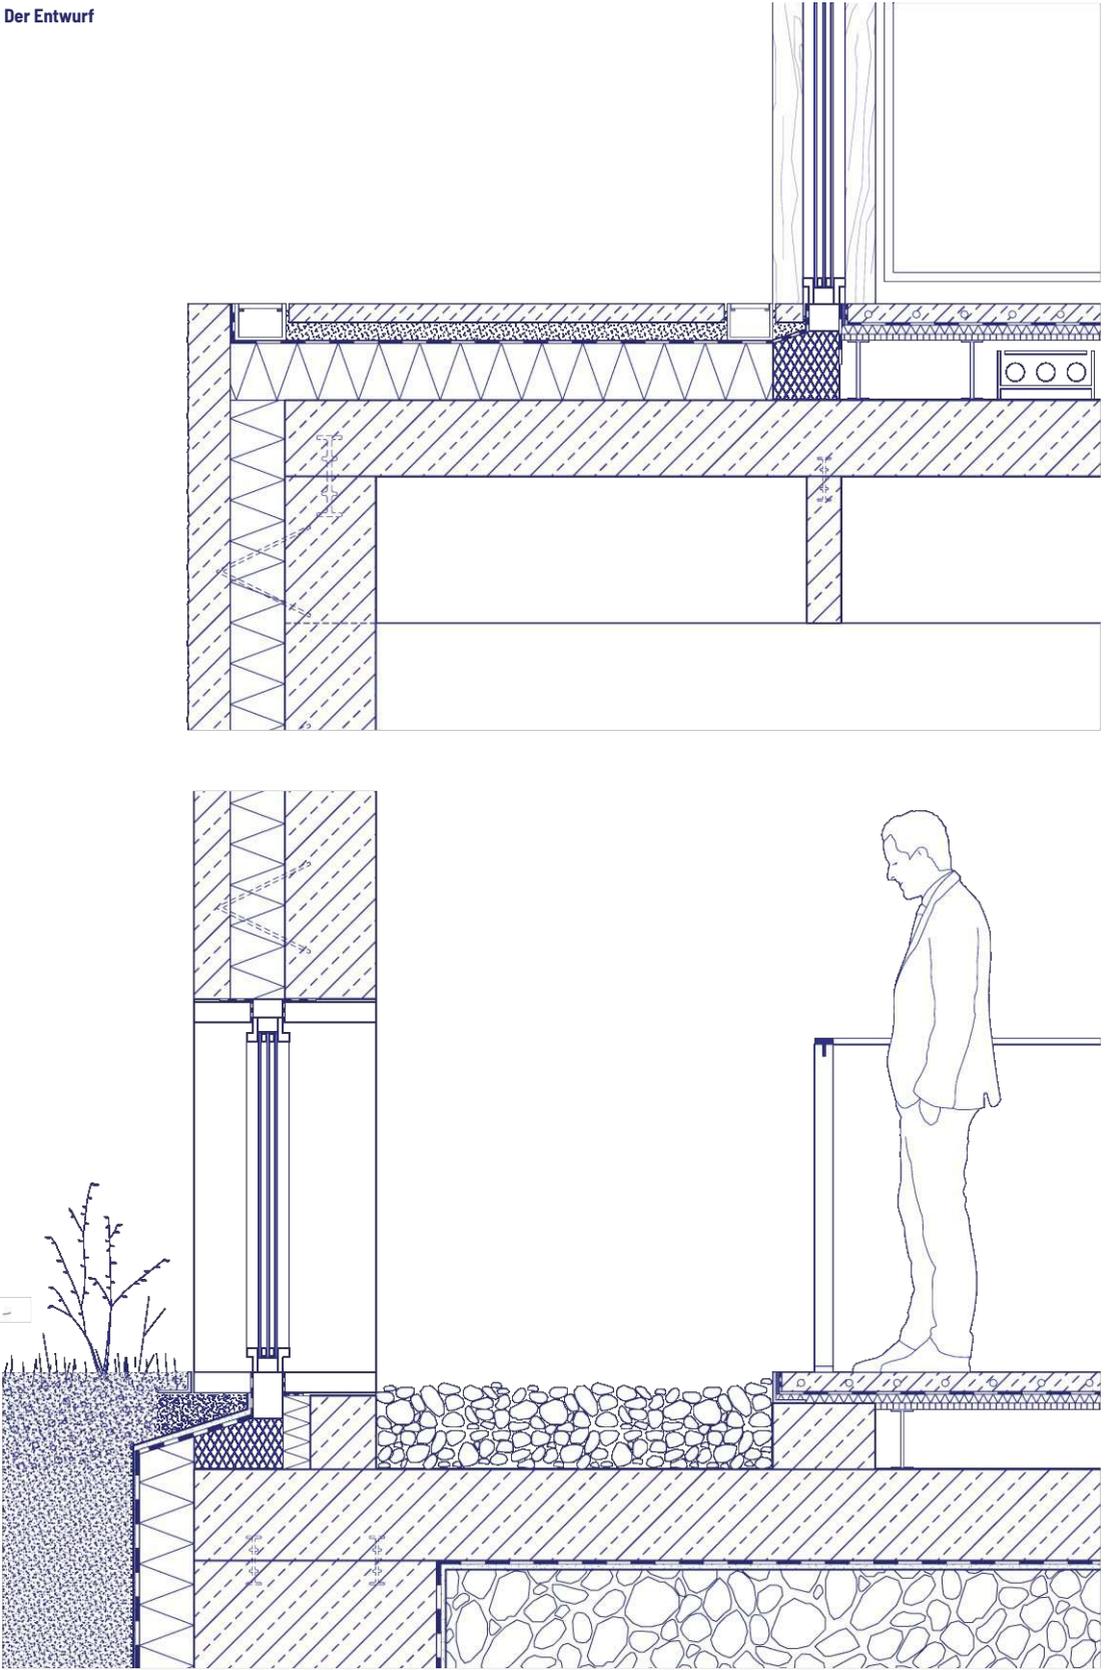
Detail Längsschnitt Ausstellungsraum, M 1:25
